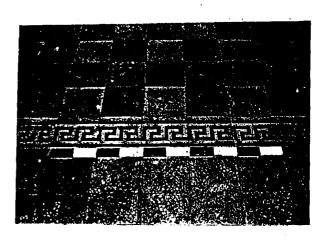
/100347 Detail lantai "emperan" bangunan belakang
